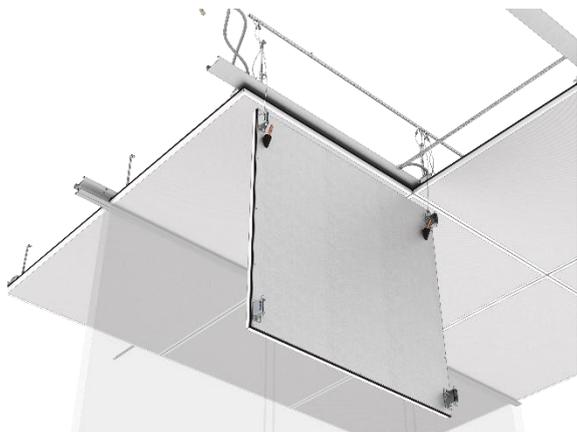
Abgeklapptes Deckenelement mit Aufhängung
